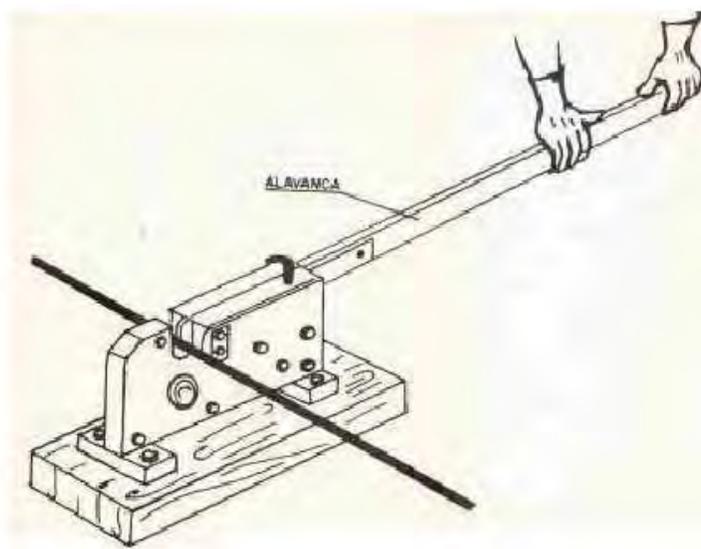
Ilustração de máquina mecânica para corte do aço. Fonte: SENAI (1980) apud BARROS e MELHADO (2006).
